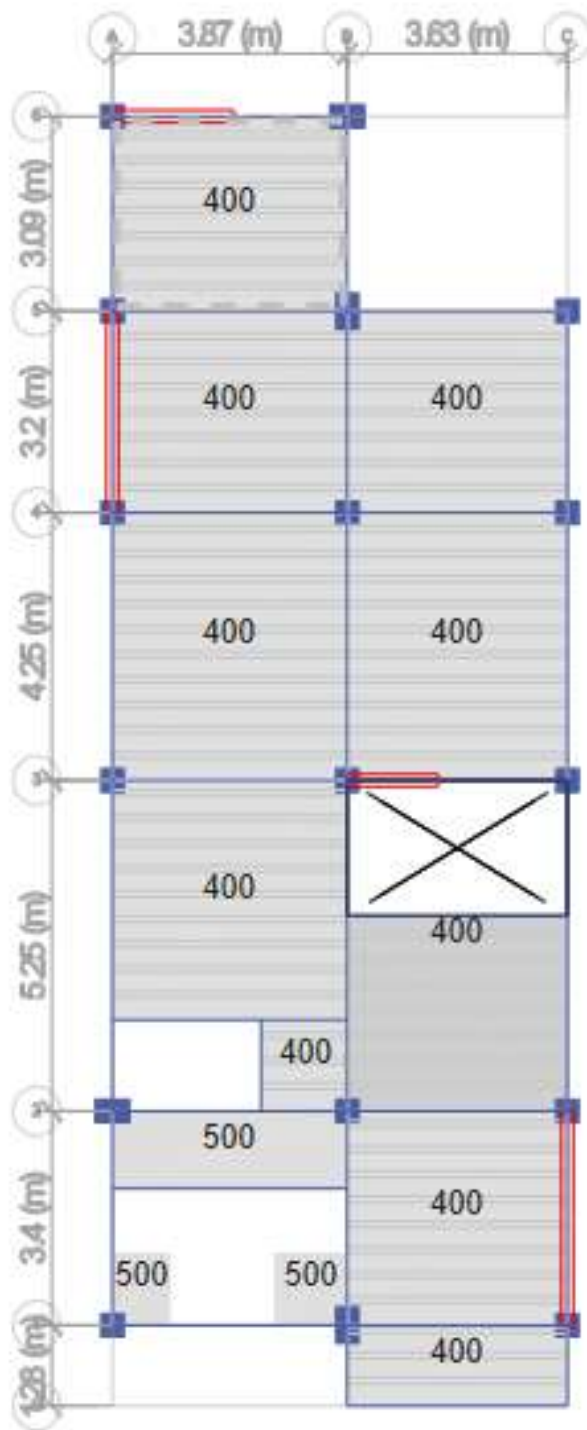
Vista en Planta de Asignación de Carga viva al 4to piso, así como de escalera exterior
